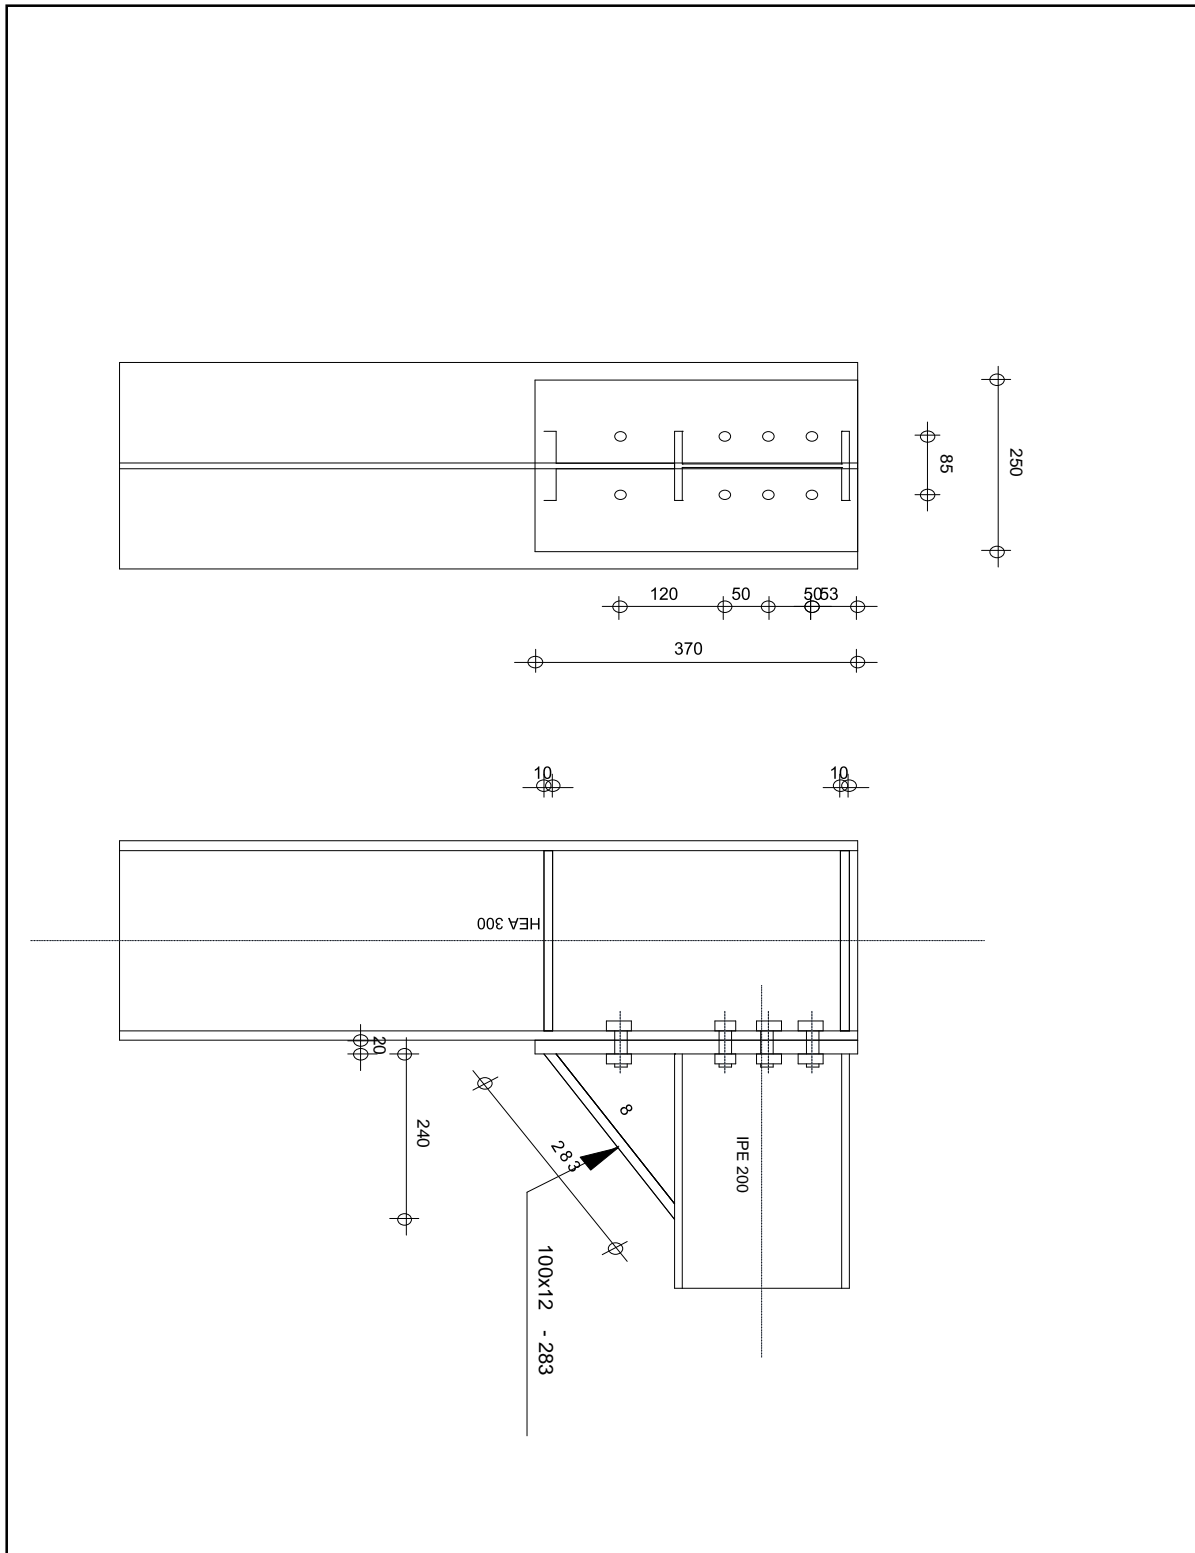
Schéma D'assemblage console-poteau (HEA240-HEA300).
